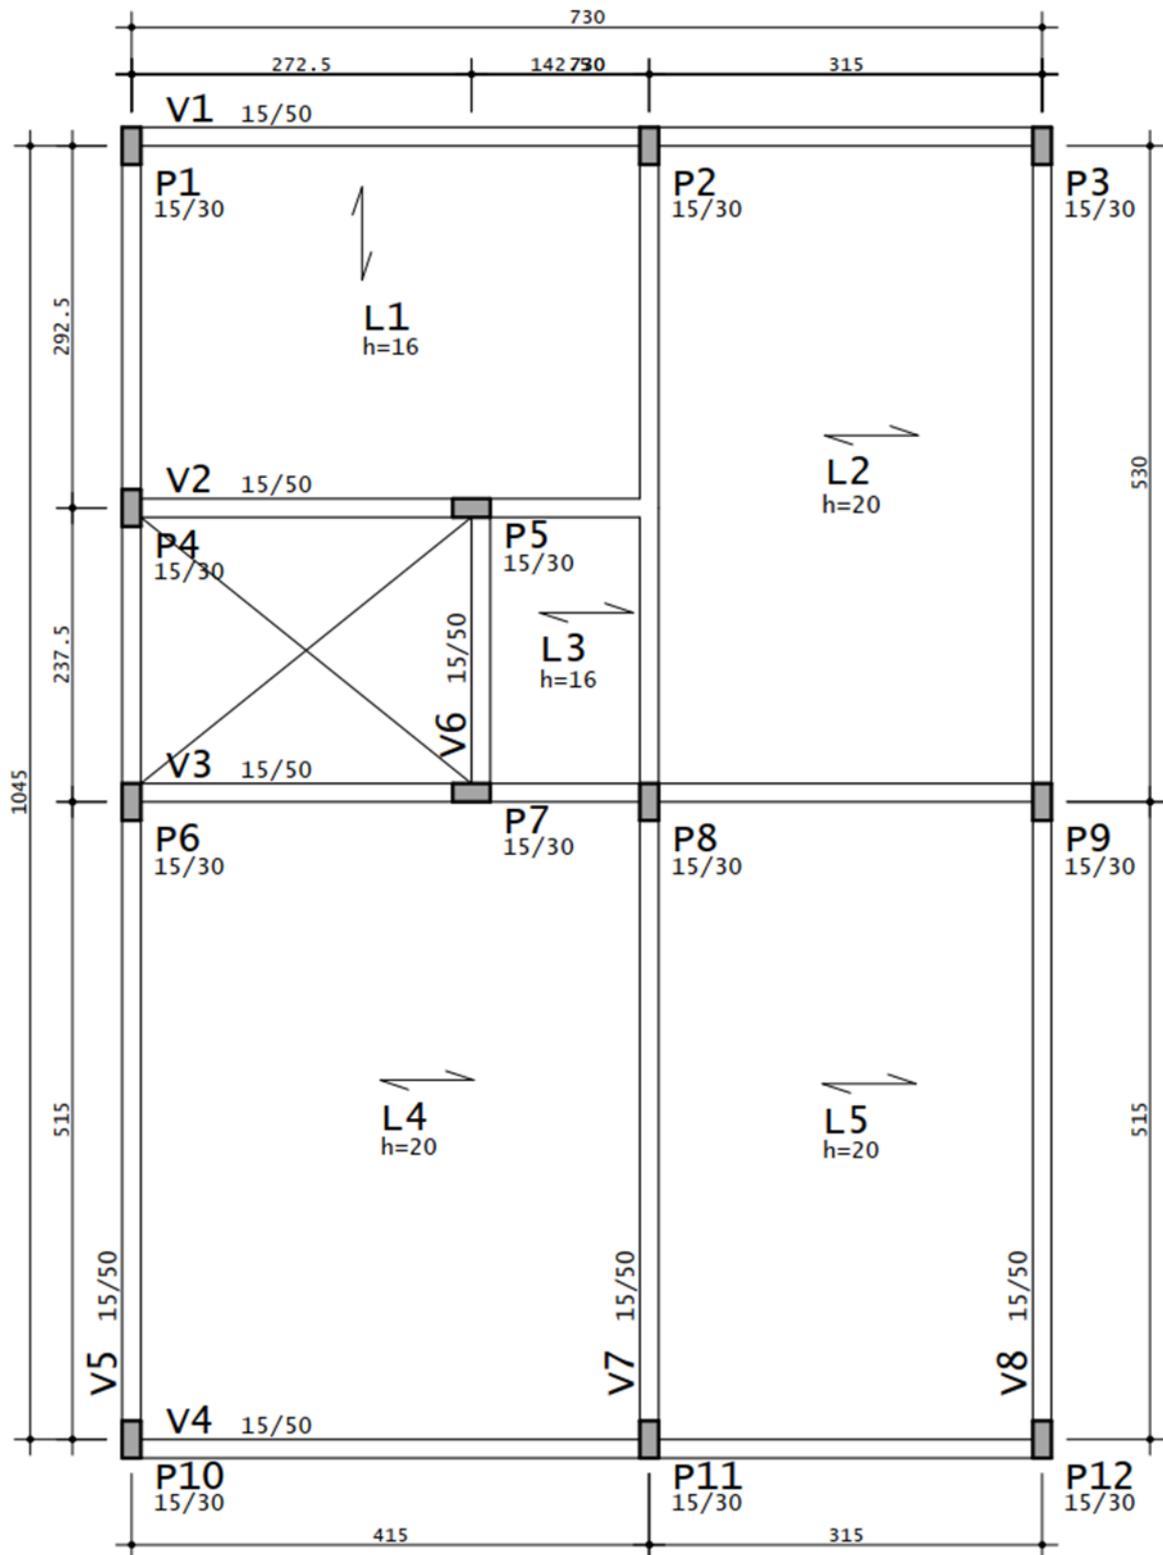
Planta de forma da cobertura da estrutura moldada no local (nível +6,00)
